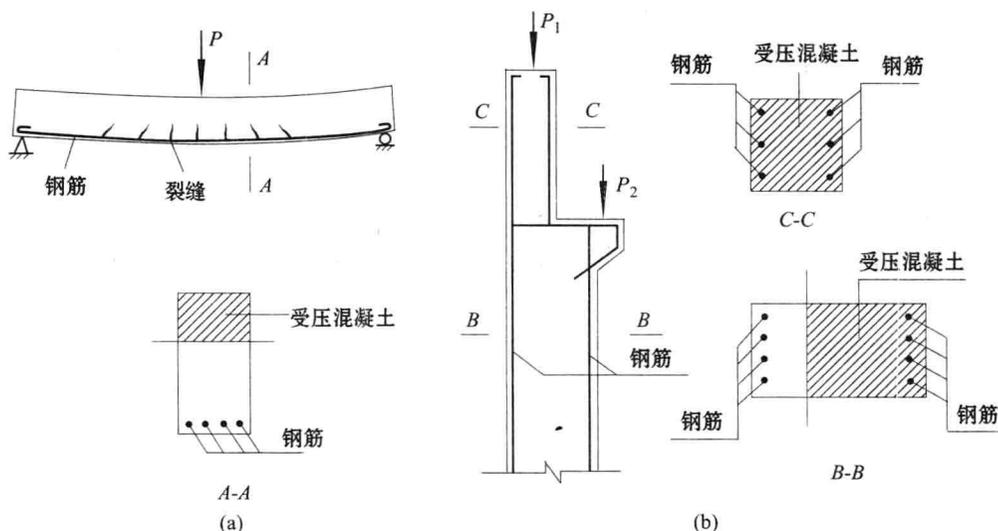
钢筋混凝土构件钢筋配置方式和一般工作原理
